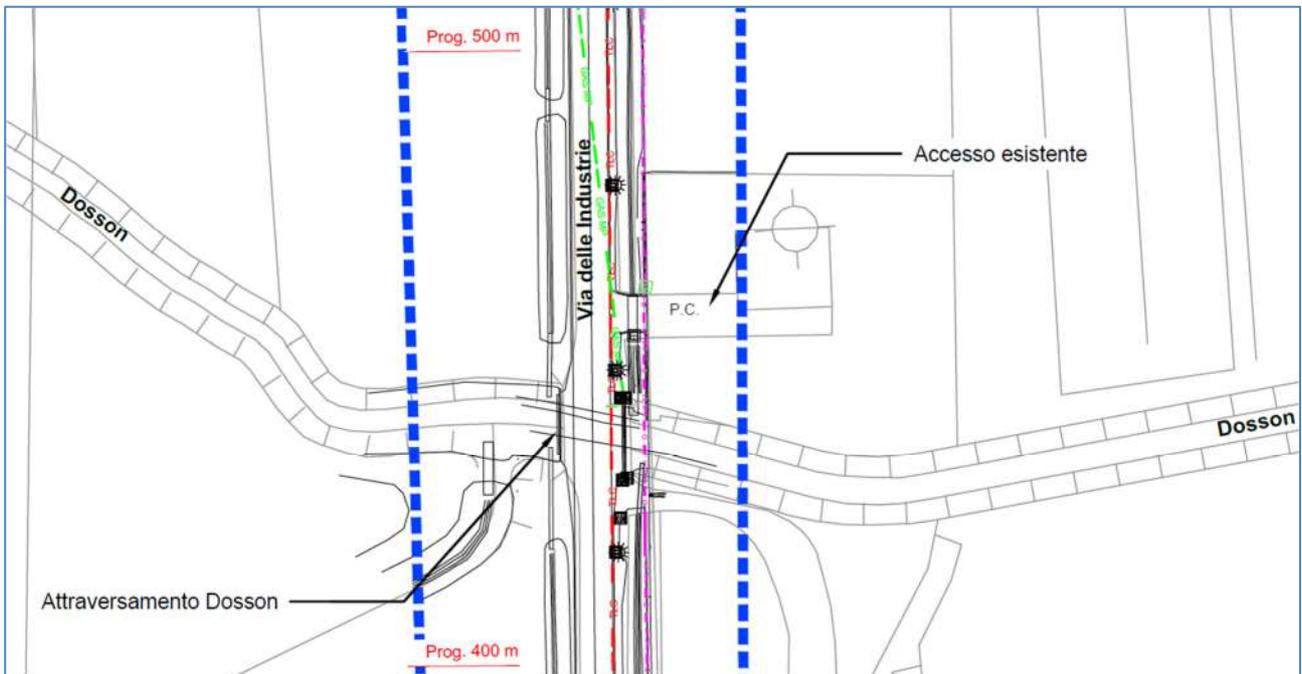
Estratto dalla tavola dei sottoservizi rilevati (attraversamento Scolo Dosson).
